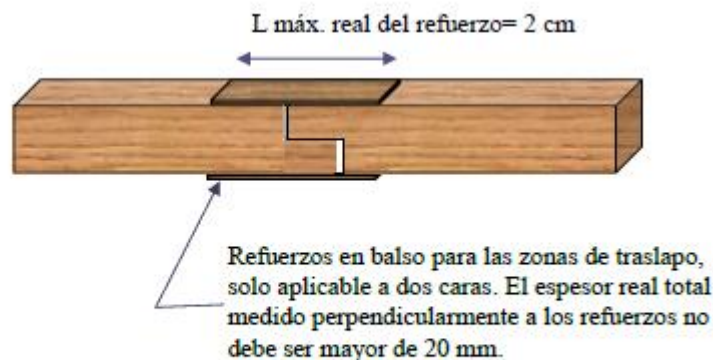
Refuerzos en las zonas de traslapos entre piezas de balsa.
